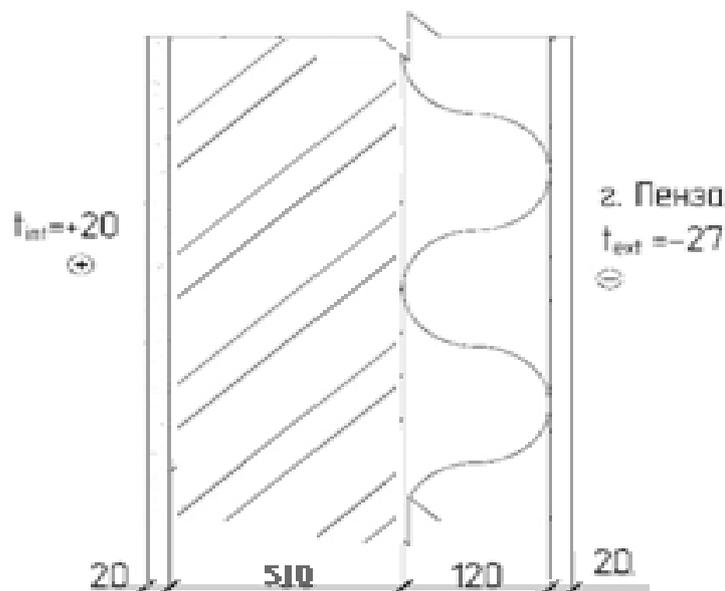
Конструкция утепления стены снаружи с использованием в качестве утеплителя плит из пенополистирола.
